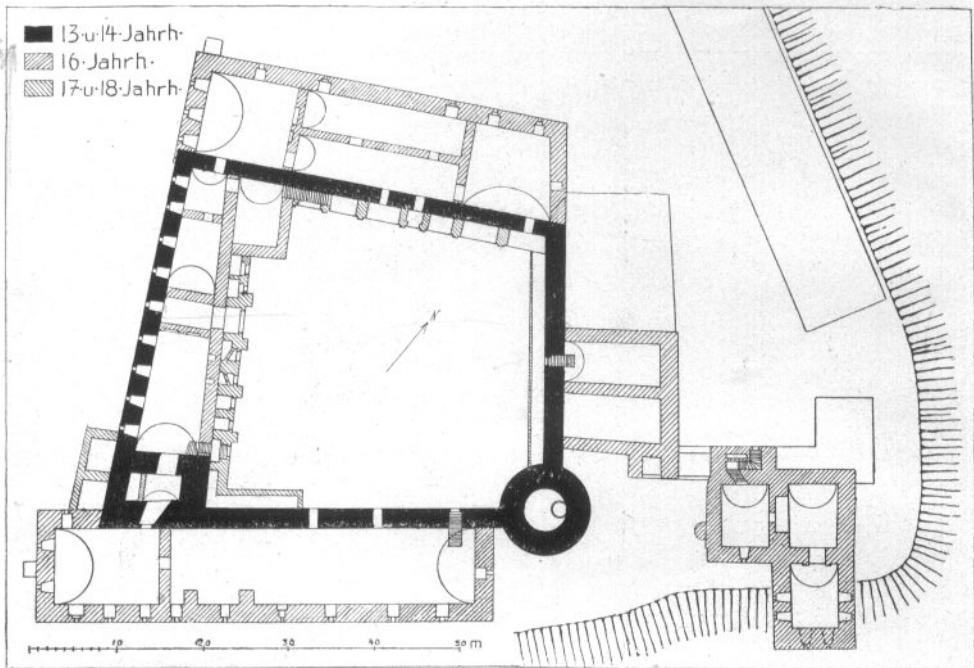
Schloß in Oels. Grundriß des Kellergeschosses. Rechts vorn das ältere Walltor.
